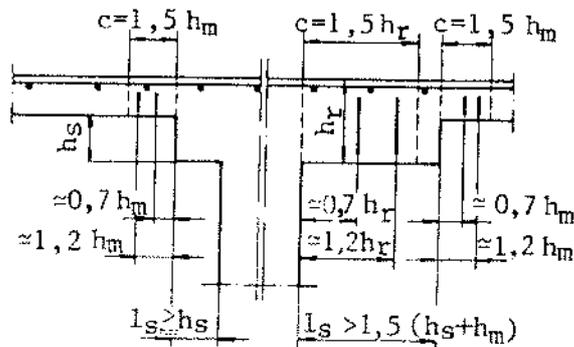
Losa con refuerzo en el capitel de apoyo en el caso de peligro de punzonado (ejemplo de armadura de corte).
